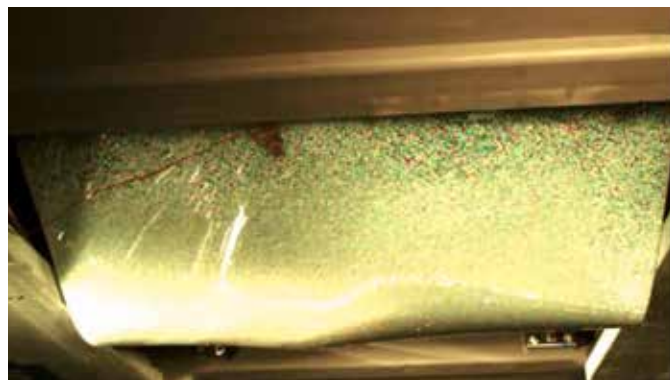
Ionomer-Laminat wird nicht durchgeschlagen
